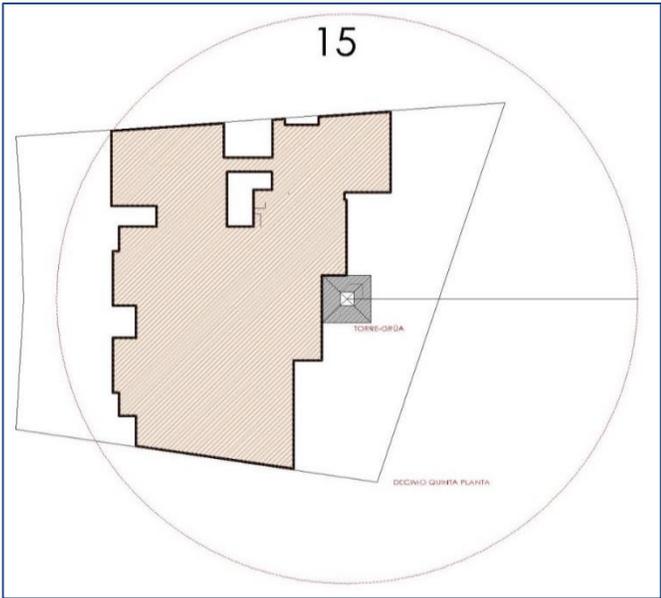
Layout del Proyecto Piso 15. Fuente: Elaboración Propia
